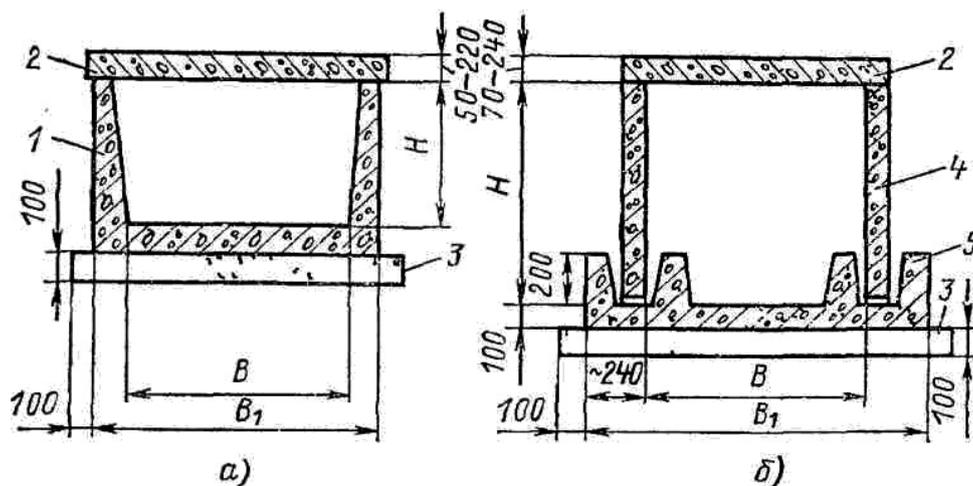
24. Сборные железобетонные каналы: а - лотковые типа ЛК; б - из сборных плит типа СК, 1 - лоток; 2 - плита перекрытия; 3 - подготовка песчаная; 4 - плита; 5 - основание
